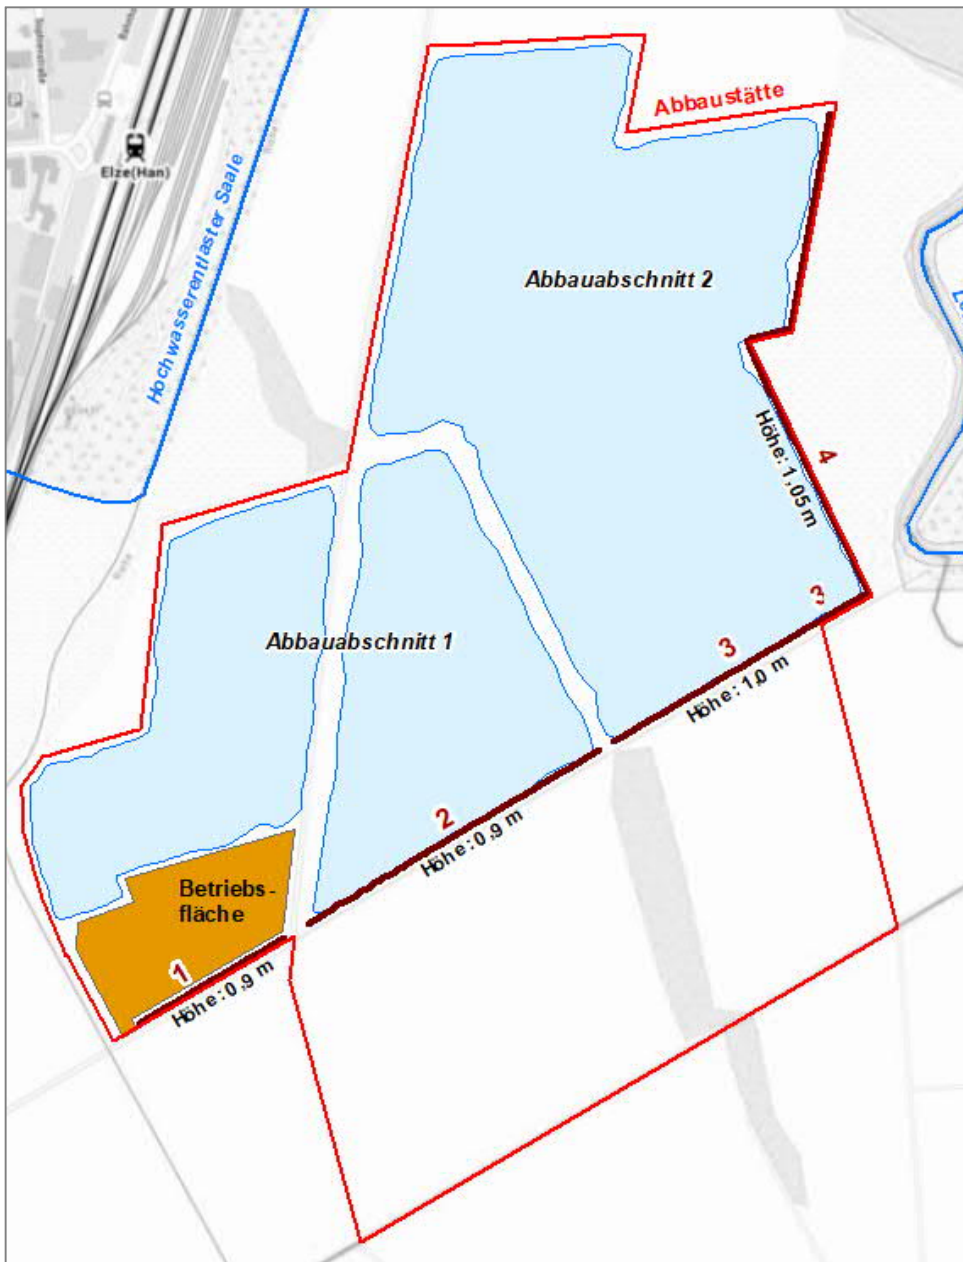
Lageplan Verwallungen Abbauabschnitt 2
